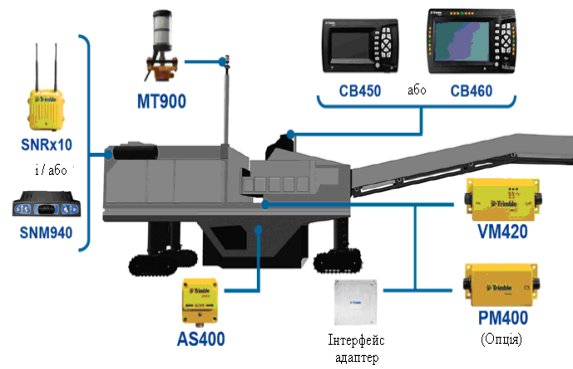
Схема розташування бортових елементів САУ Trimble PCS900
